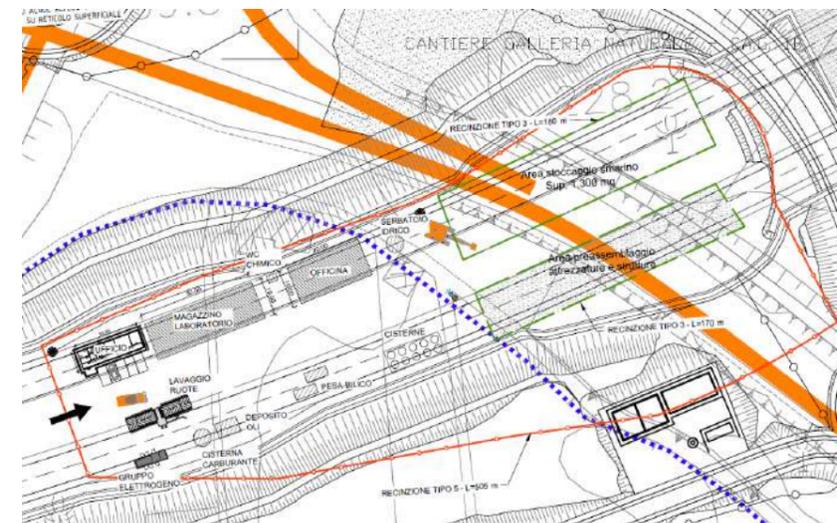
Planimetria del cantiere operativo CA.G.1B.
